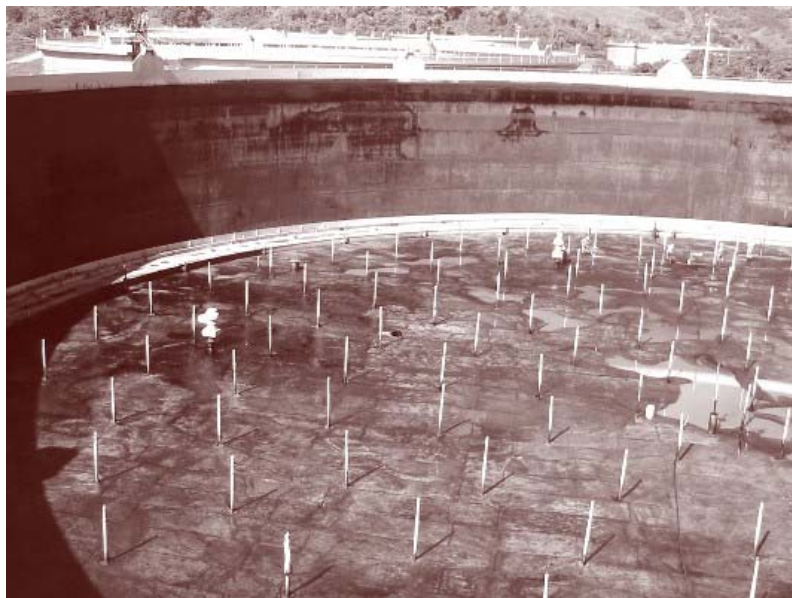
Tanque con techo flotante interno y techo cónico soportado por armaduras
